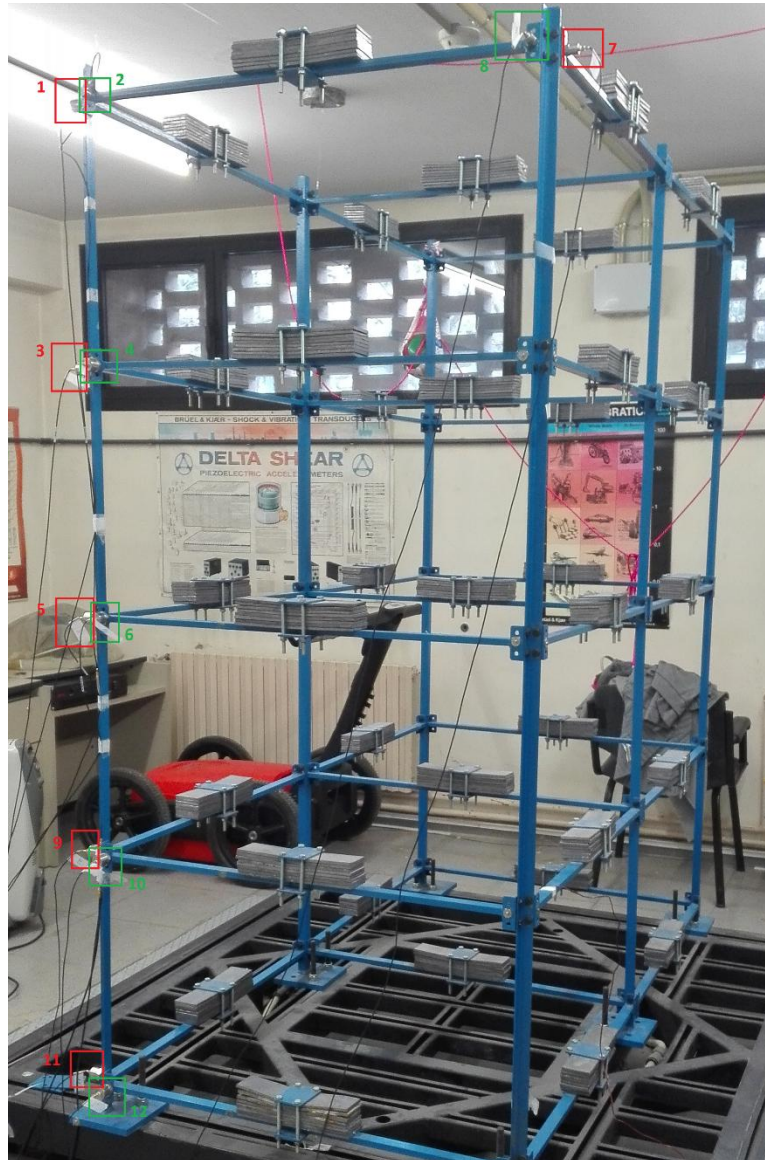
Fotografía de la estructura con los acelerómetros en la dirección transversal indicados en rojo y en verde para la dirección longitudinal. El número al lado de cada acelerómetro indica el canal de registro.
